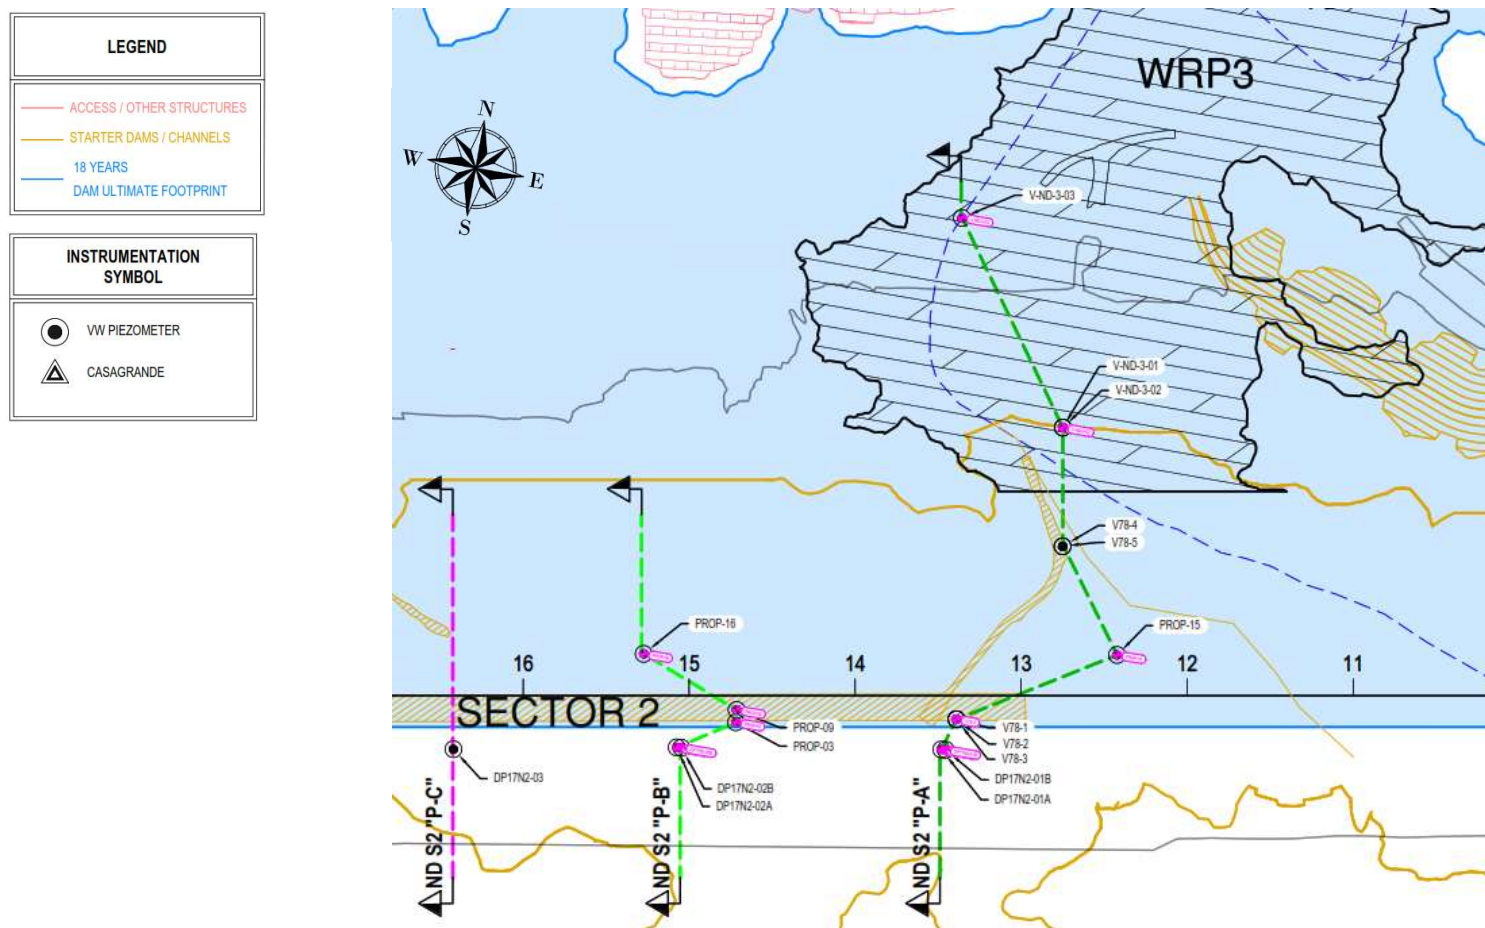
1: Vista en planta del sector 2 de ND - Grupos de instrumentos Piezometro y Casagrande
